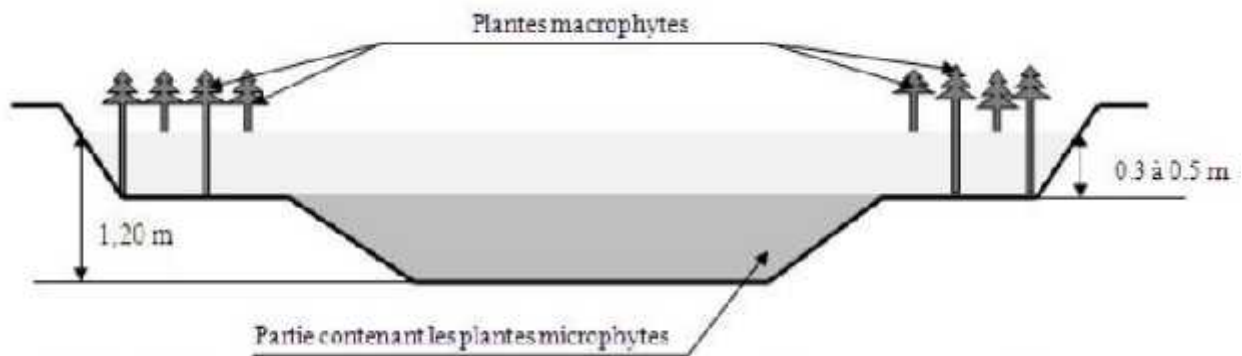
Schéma d'une lagune mixte (ARDAM, 2007)
